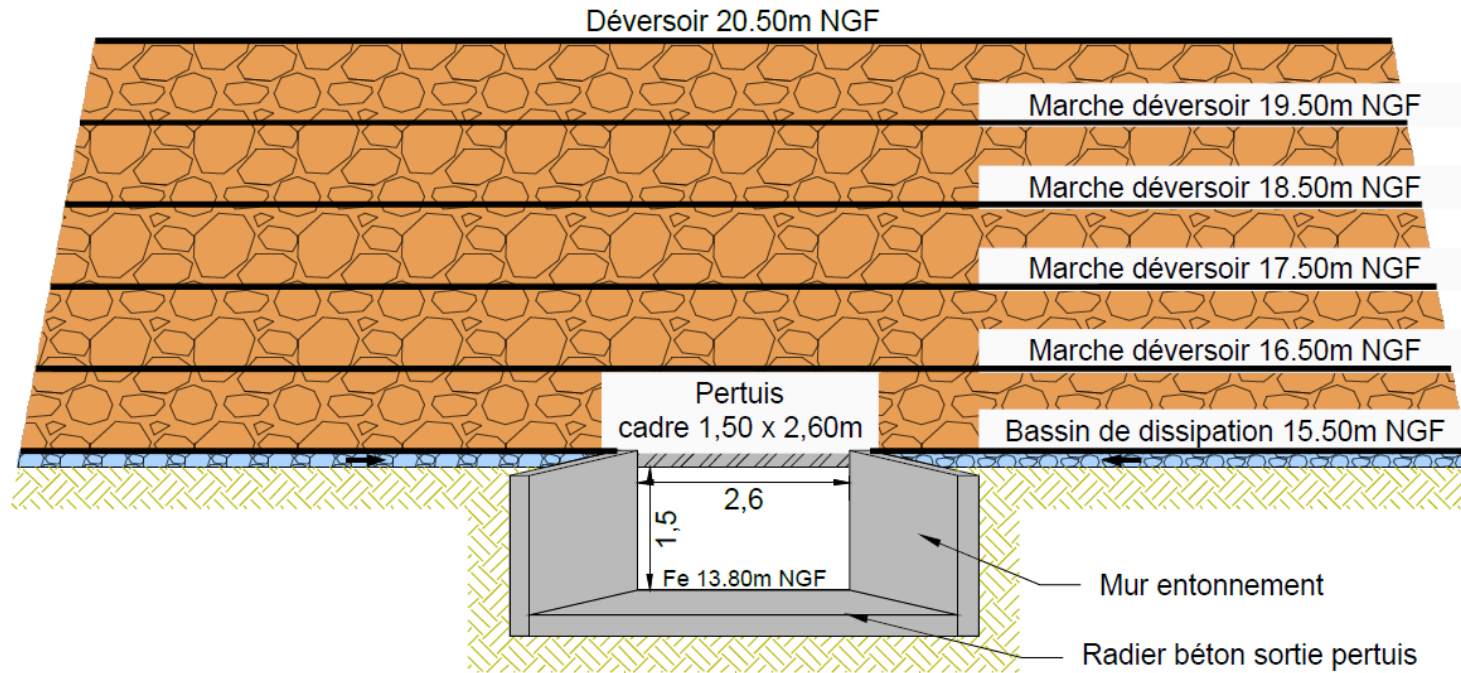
Profil en travers au droit du pertuis de fond face aval – plans AVP
